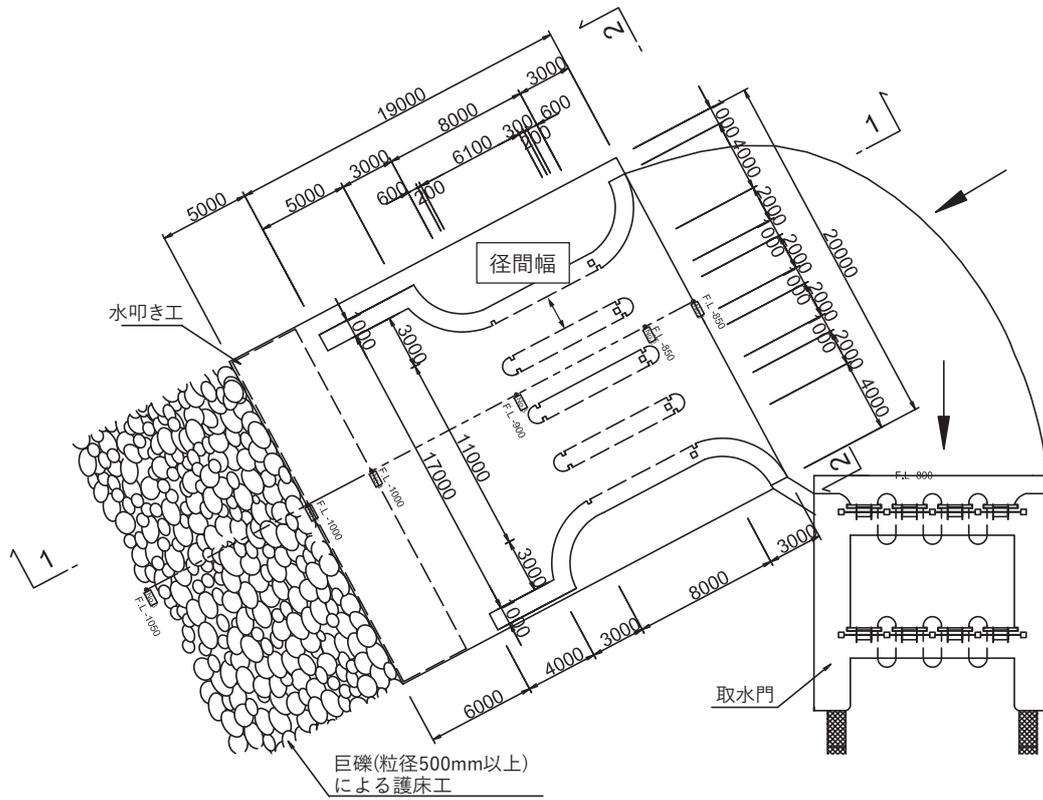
土砂吐きの平面図例<sup>3)</sup>
